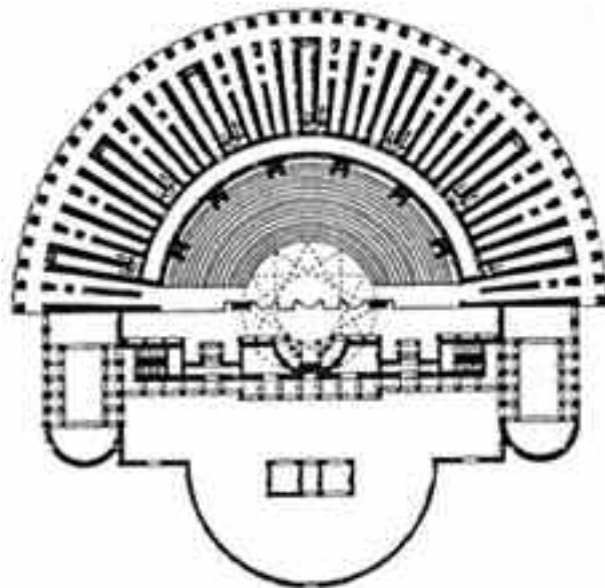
Roma, *Teatro di Marcello*, restituzione planimetrica
